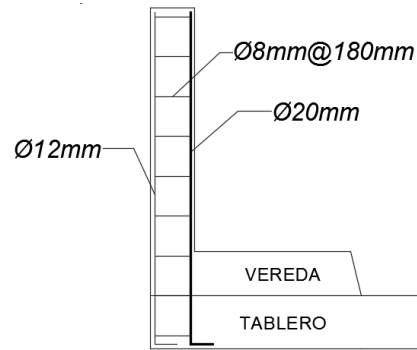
Vista frontal de la sección transversal del armado del poste. Realizado por: Autor
